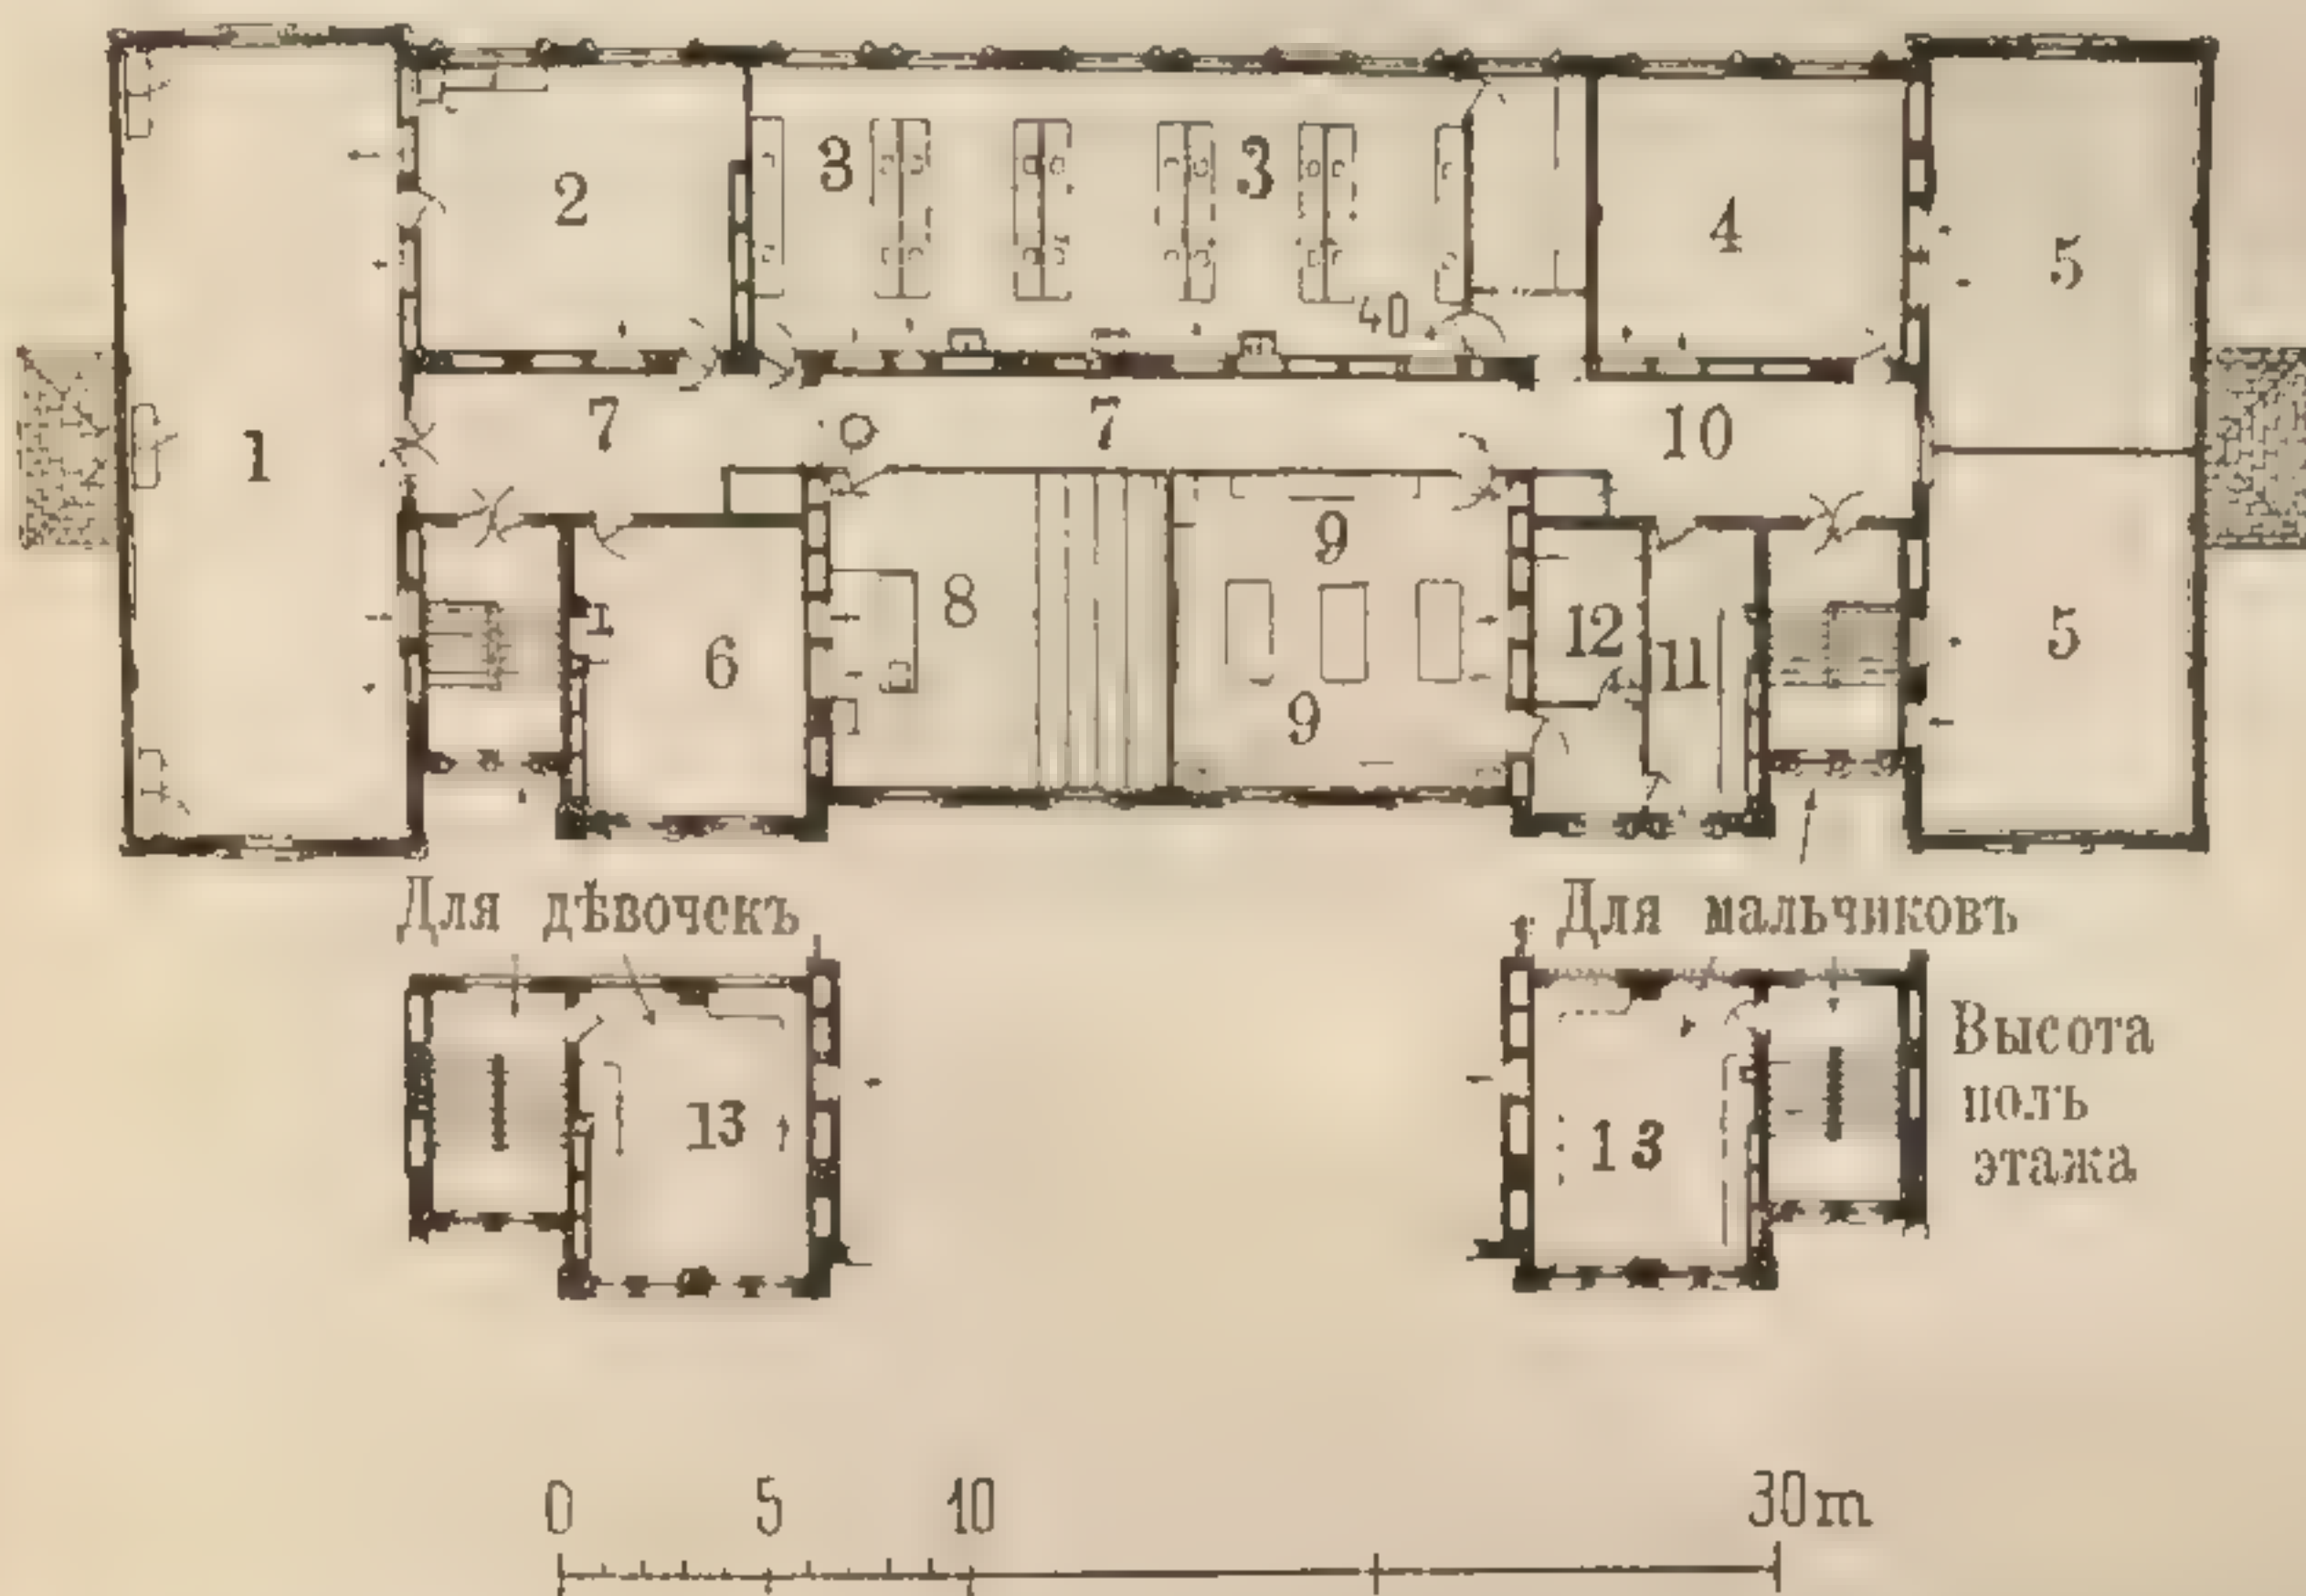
Планъ чердачнаго этажа higher grade school, Cassland road, London, по Bailey.
